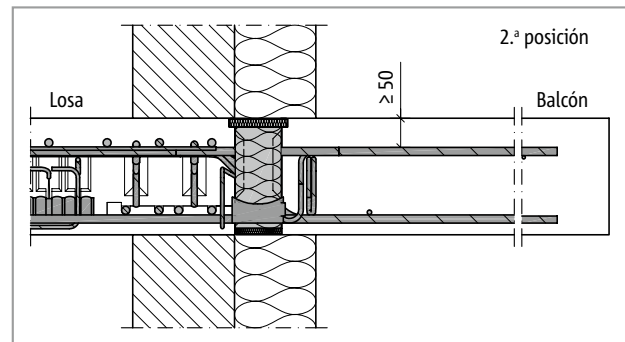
Schöck Isokorb® T tipo C: Sección 2.ª posición; conexión para sistema de aislamiento térmico exterior (SATE)
